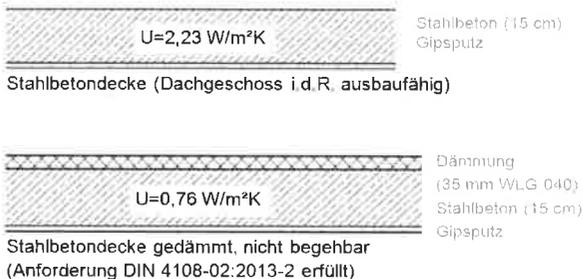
Erfüllung des Mindestwärmeschutzes bei einer Stahlbetondecke
